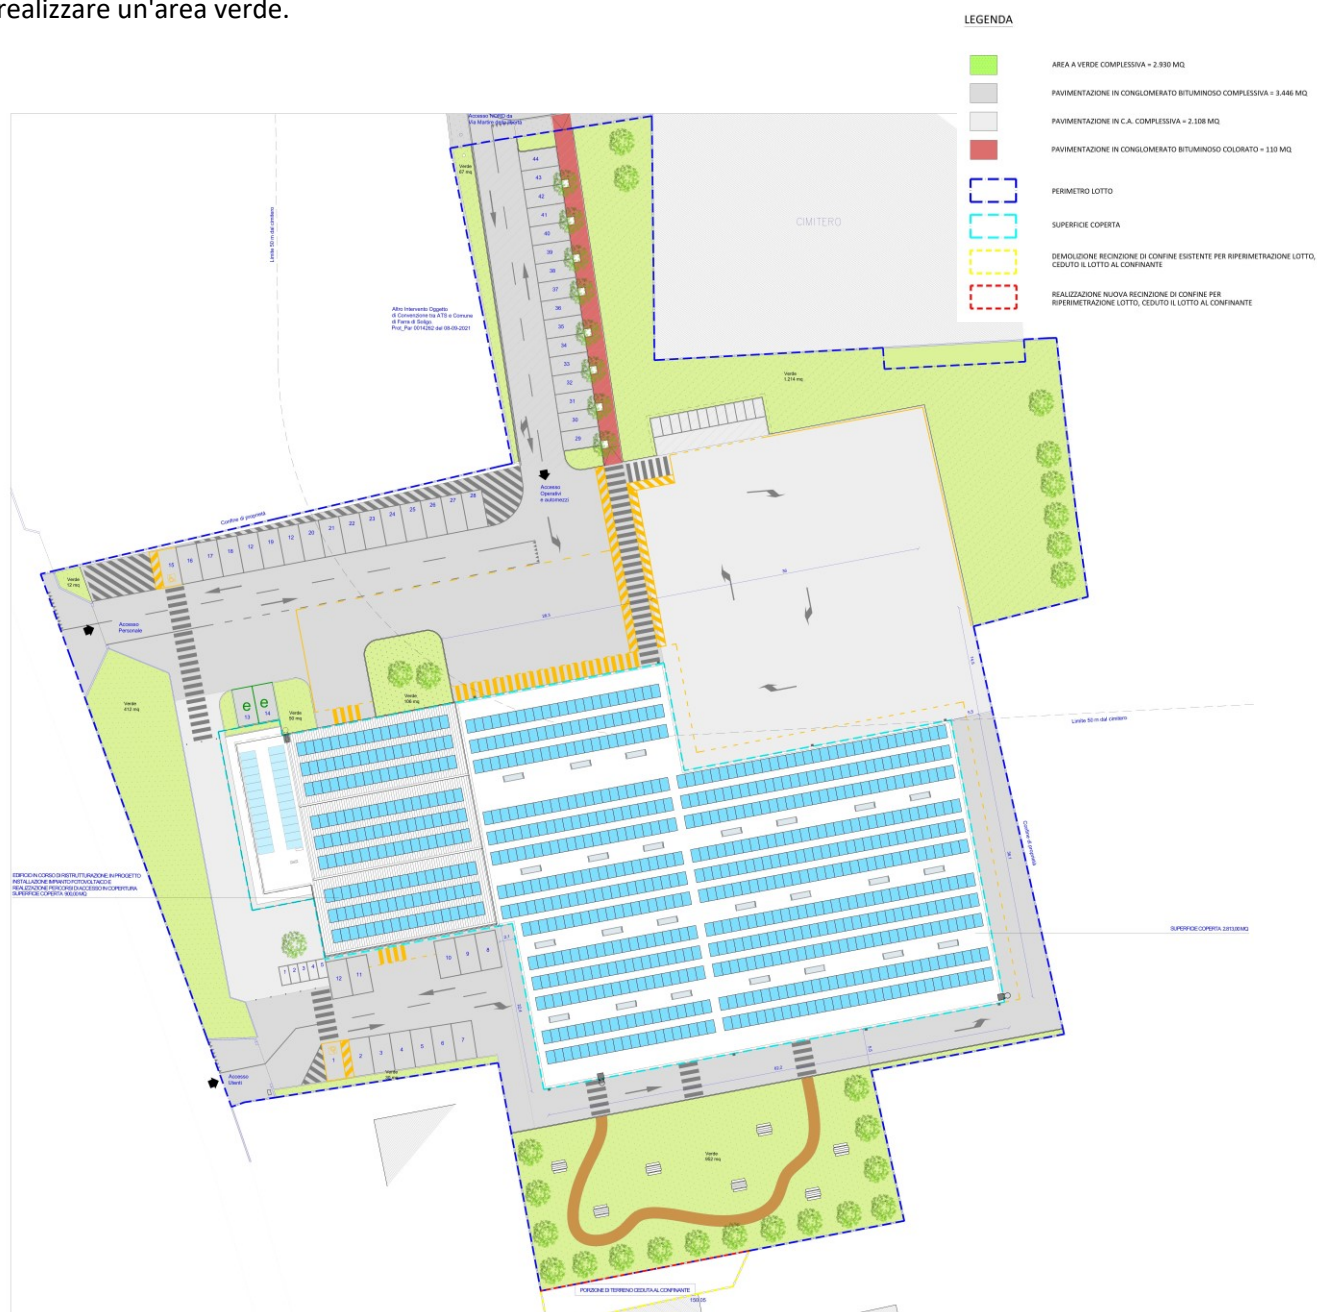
Planimetria Stato di Progetto (v. Tavola PD06)
